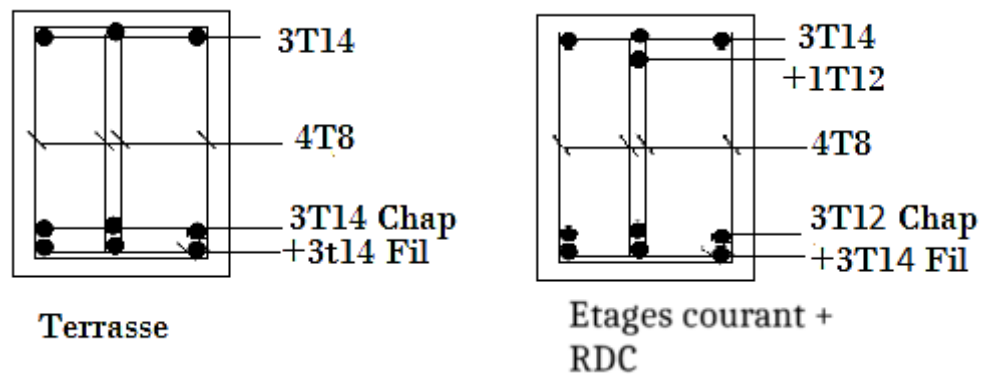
Dessin de ferrailage des sections des poutres secondaires
